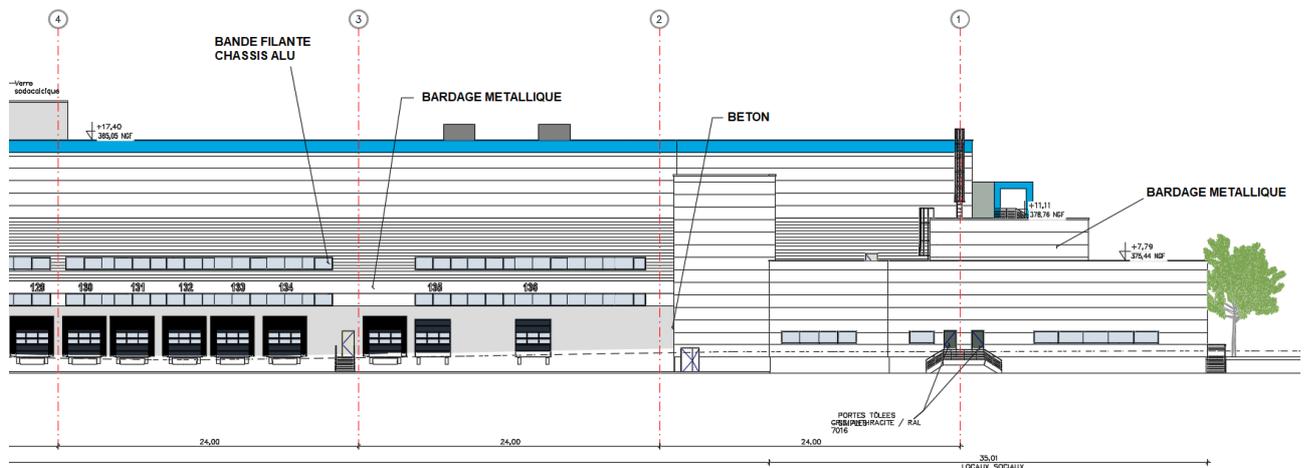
Vue sur la façade Sud entre les files 1 et 4.
